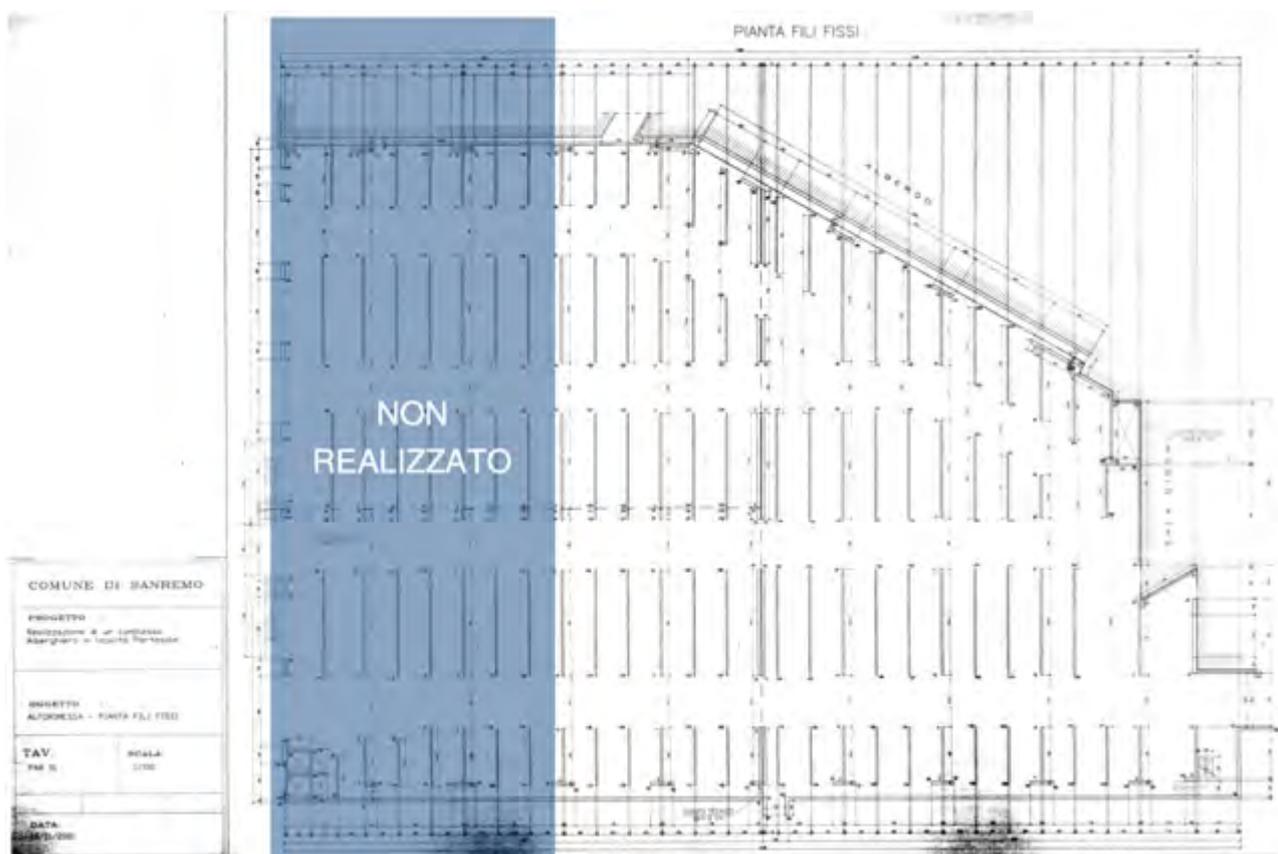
Pianta fili fissi (Progetto originale delle strutture oggetto di demolizione)
